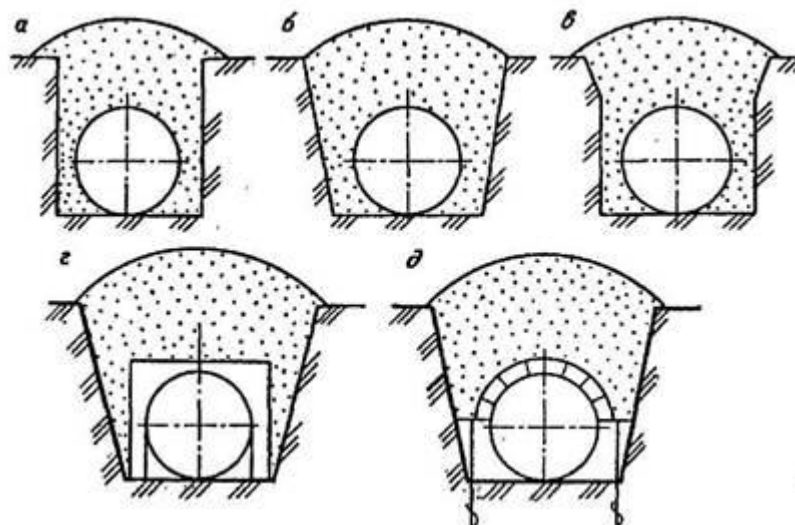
Схемы подземной прокладки трубопровода:
